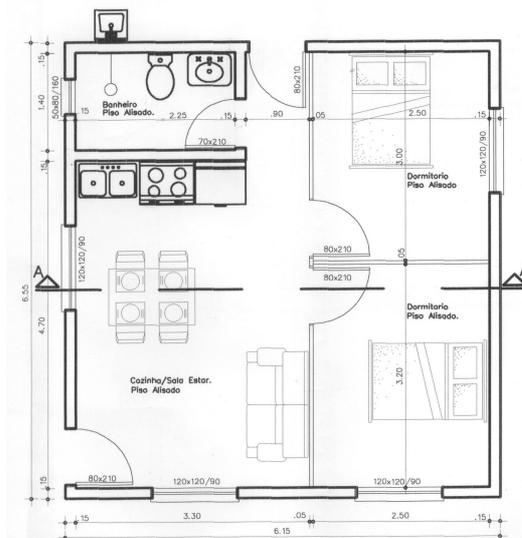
planta da unidade. Repare que na construção a porta foi trocada de lugar.
